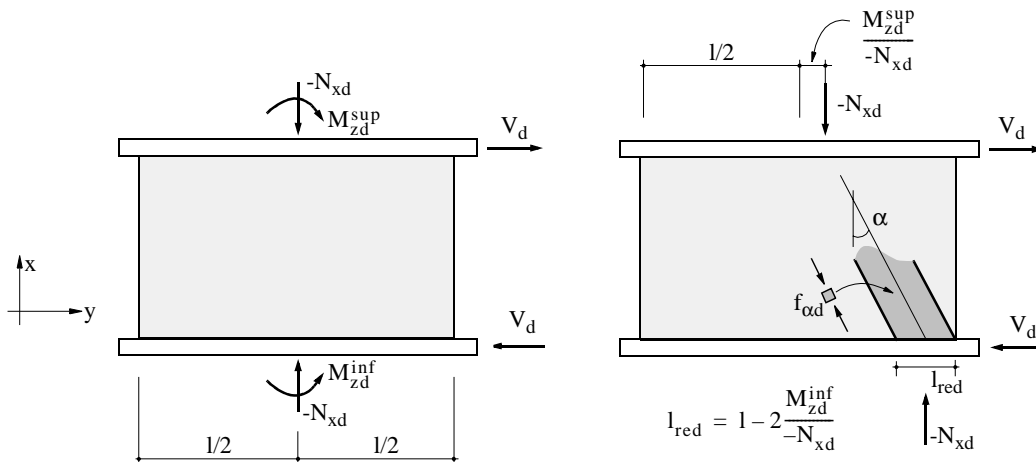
Schubwand mit geneigter Druckstrebe [60]
